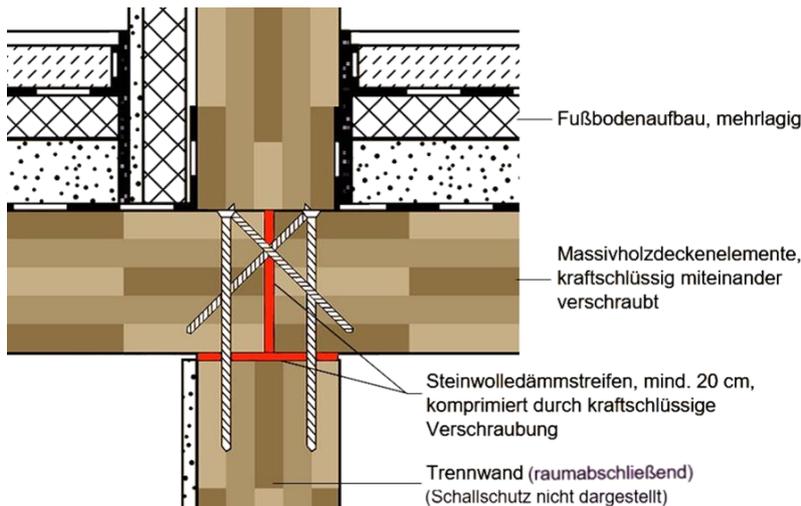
Bauteilanschluss raumabschließende Wand / Decke (Vertikalschnitt) [Muster-Richtlinie 23.05.19]
